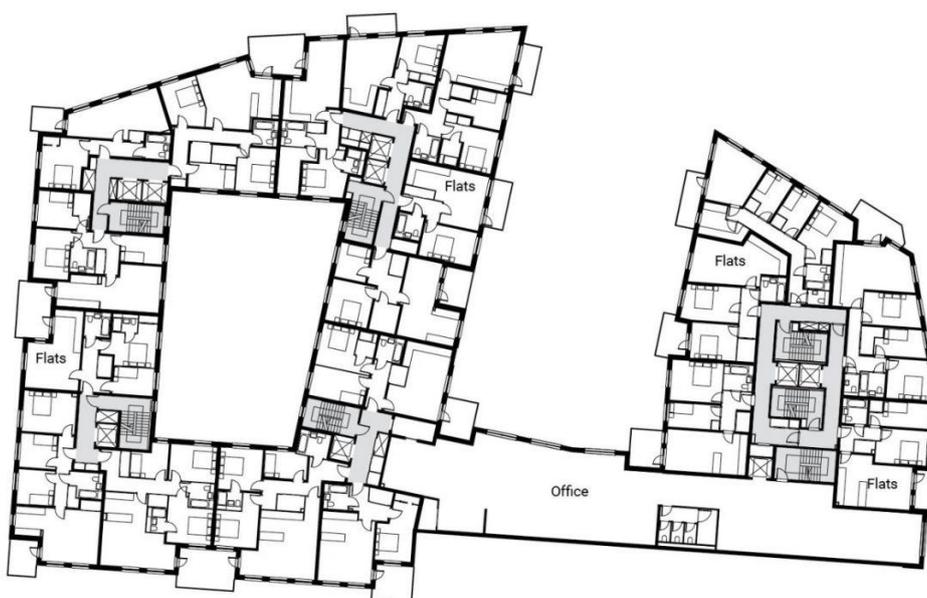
planta Dalston Works, Waugh Thistleton Architects
